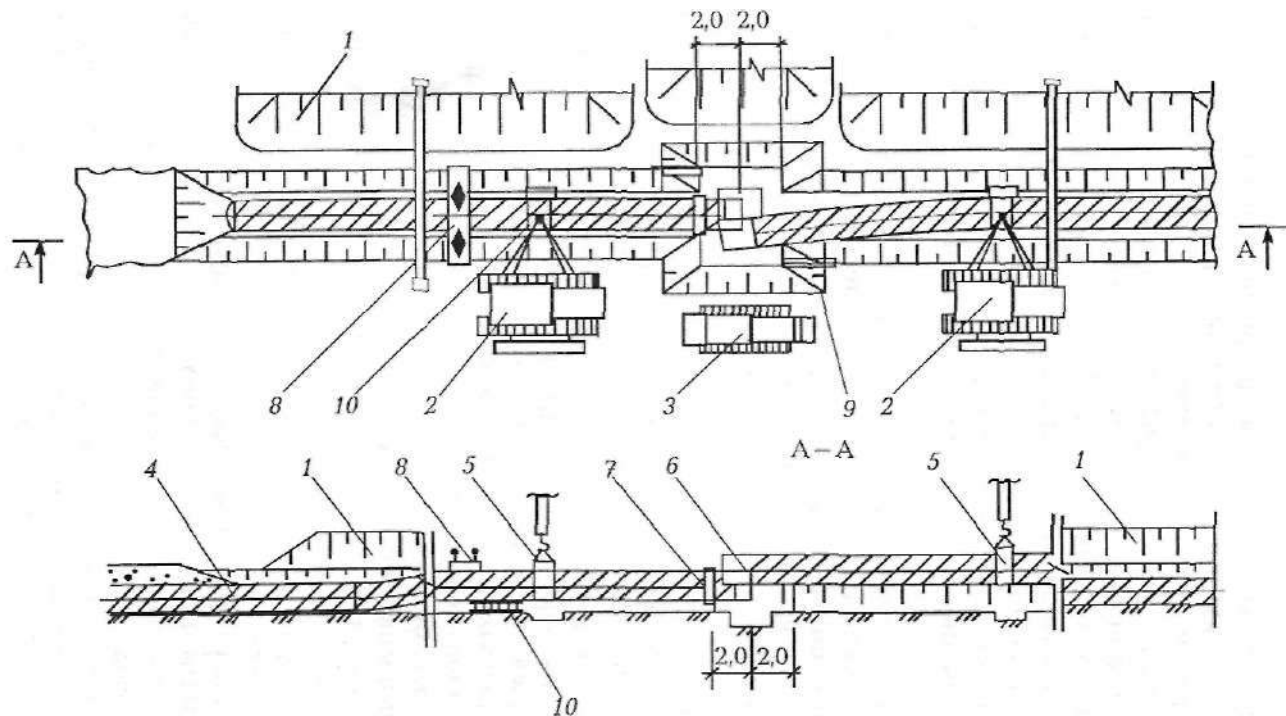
Схема производства работ при монтаже и сварке трубопровода на захлестах:
